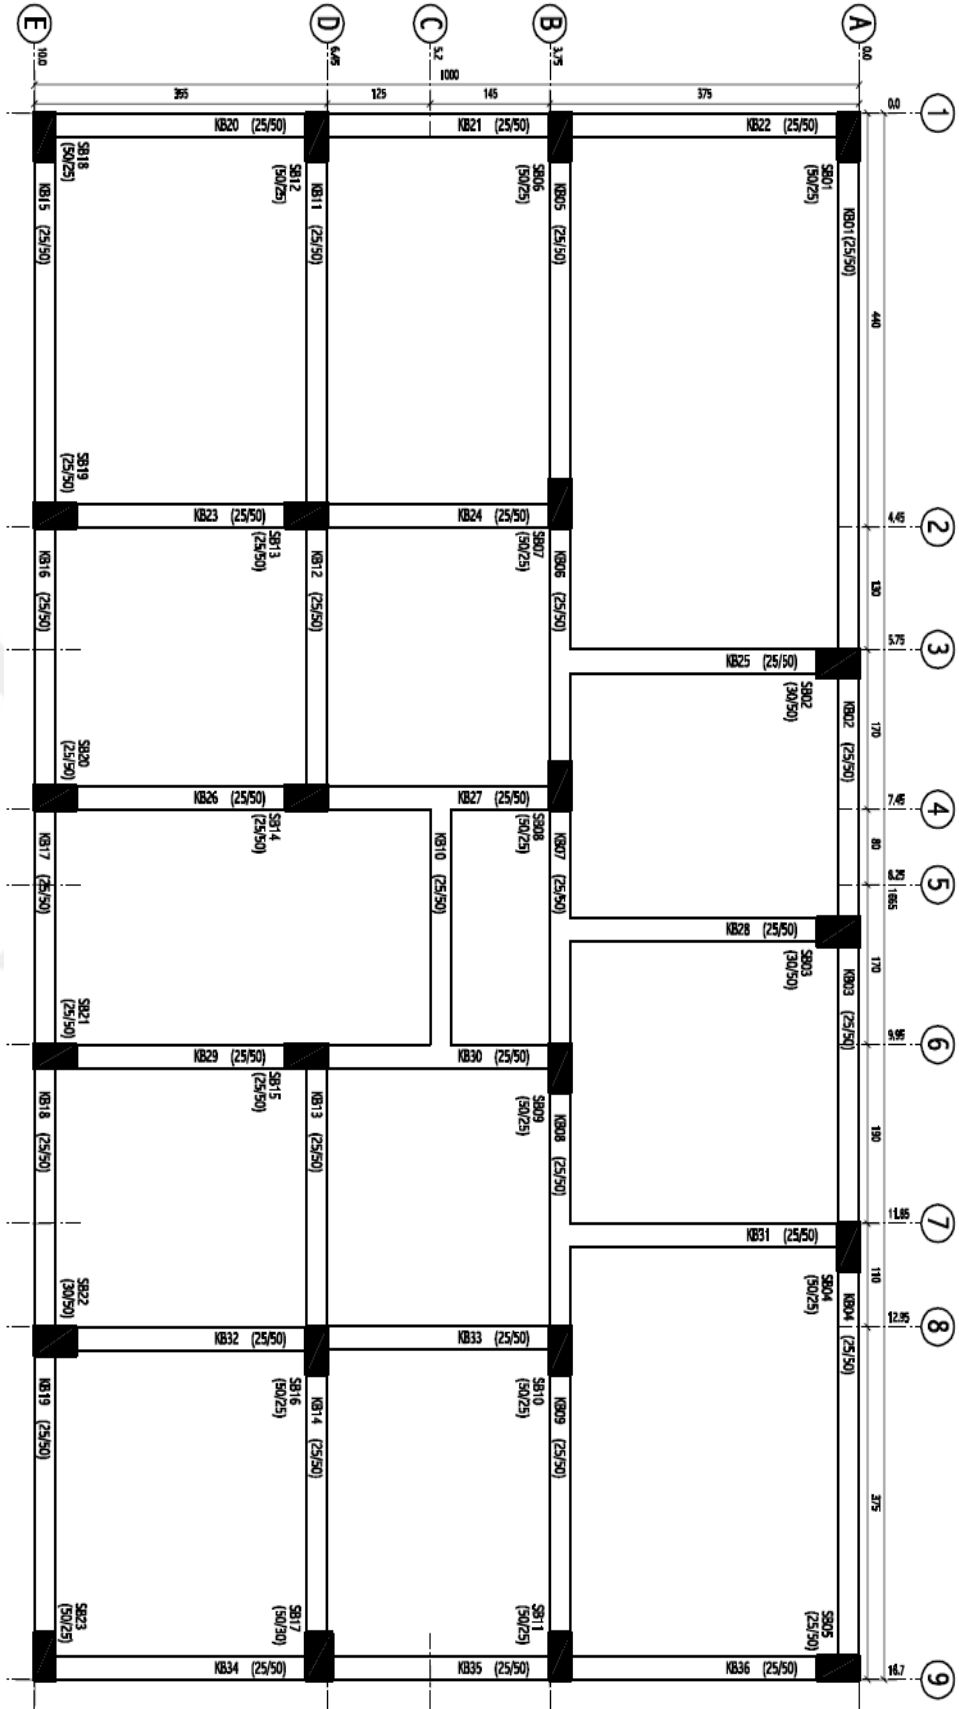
AFY-4 binasına ait kalıp planı (4 katlı)
